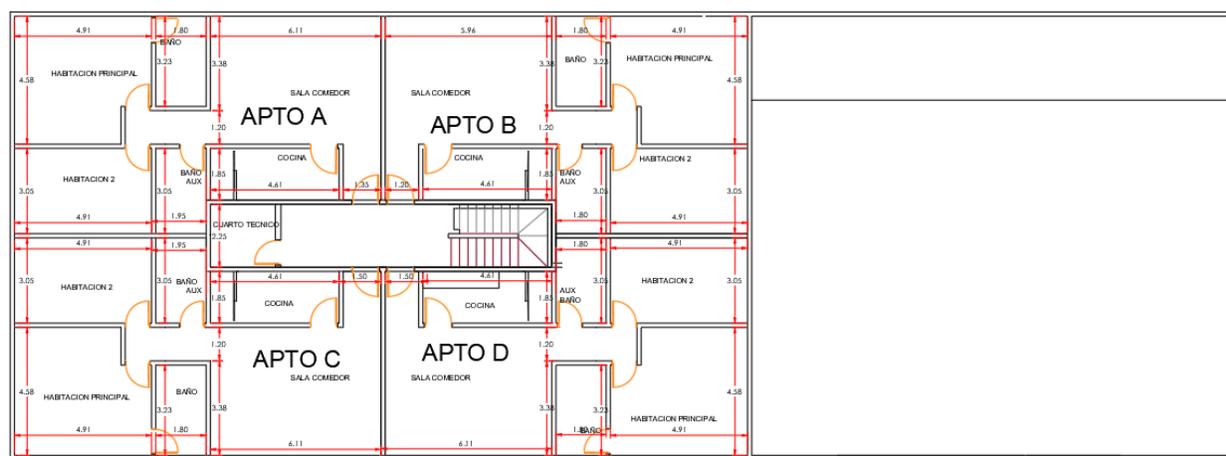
Vista en planta de primer piso, Plano Arquitectónico.
